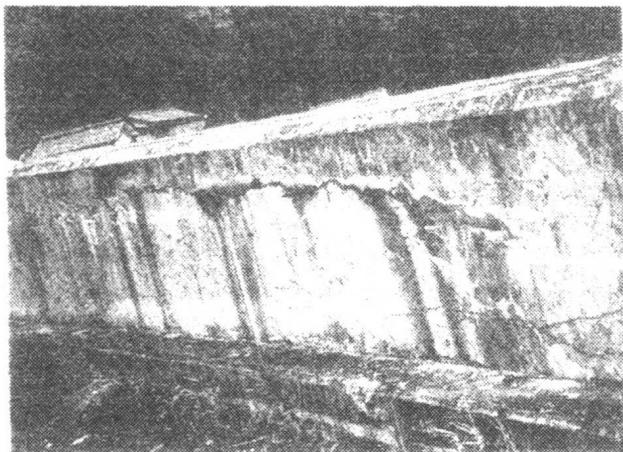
混凝土碱骨料反应钢筋混凝土桥开裂破坏实例
